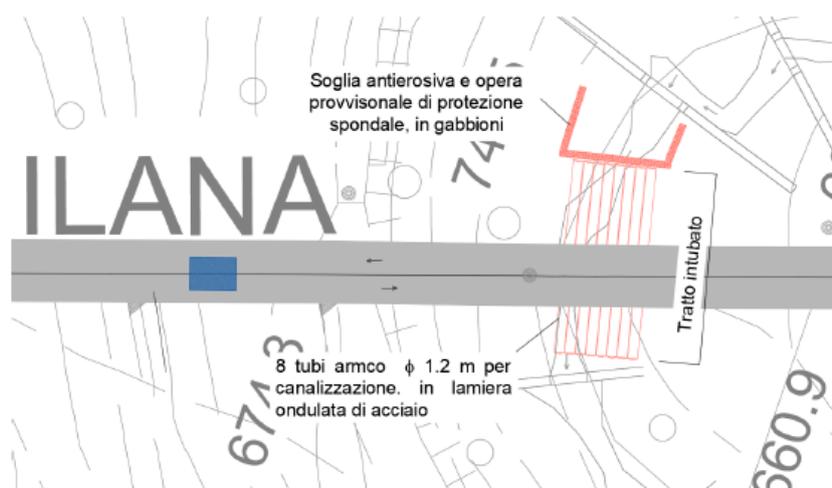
Estratto elaborato V382022002APA: posizionamento tubi armco, rappresentato in pianta
